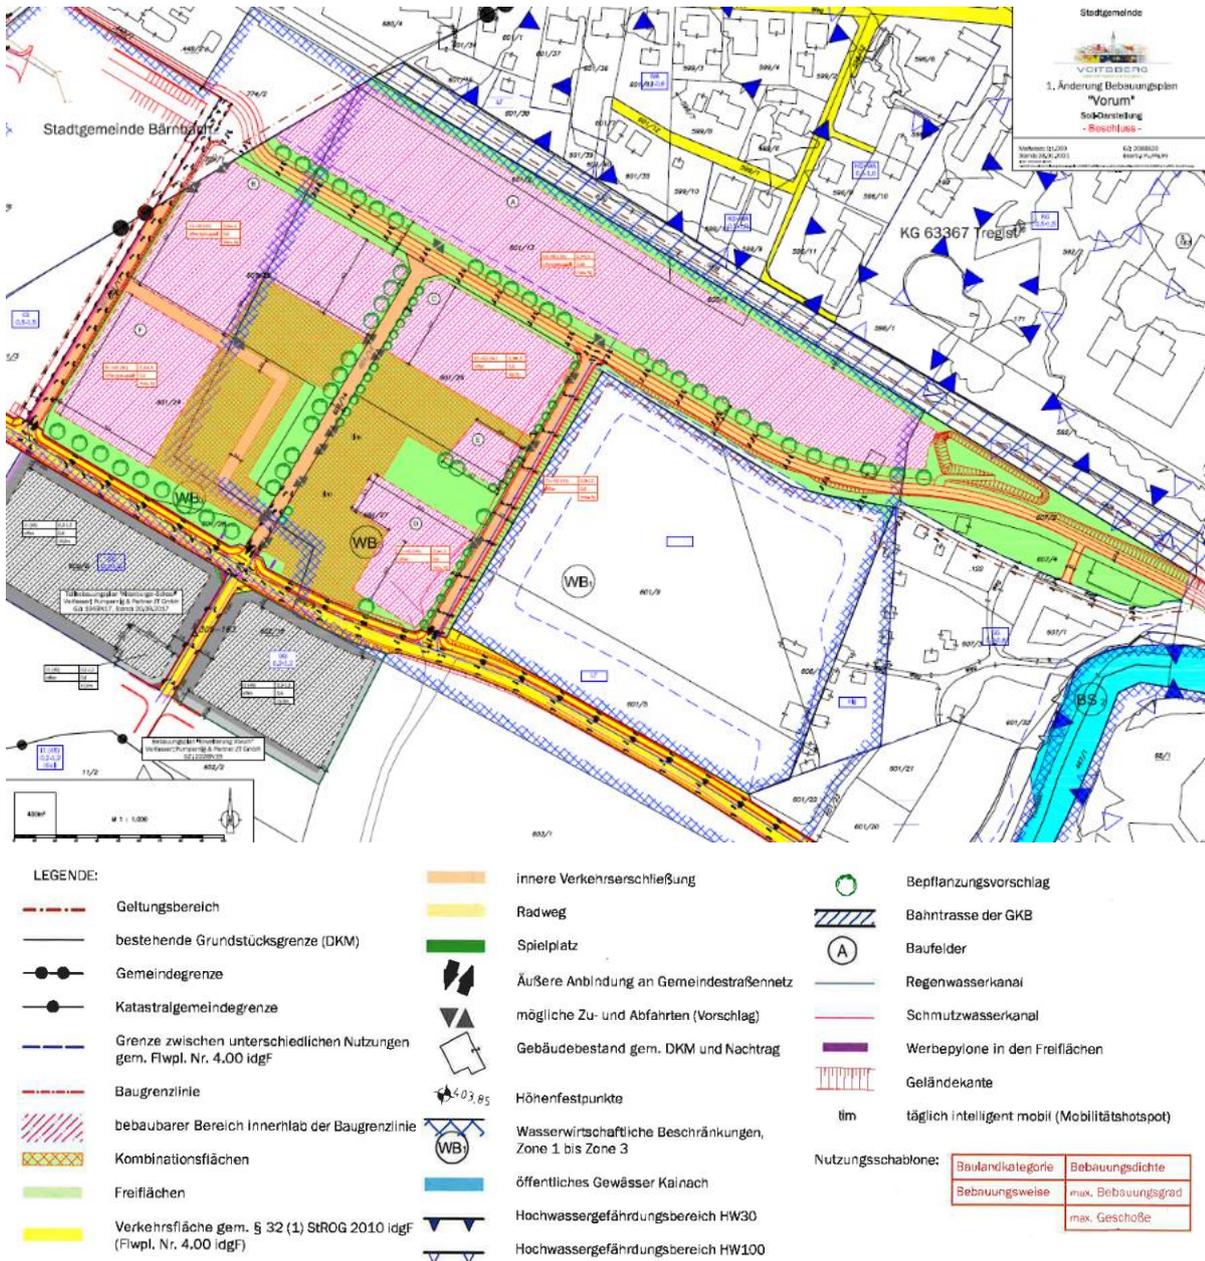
Bebauungsplan „VORUM“ Voitsberg, Planquelle: Pumpernig & Partner ZT GmbH, 13, Legenden Quelle: Pumpernig & Partner ZT GmbH, 12
